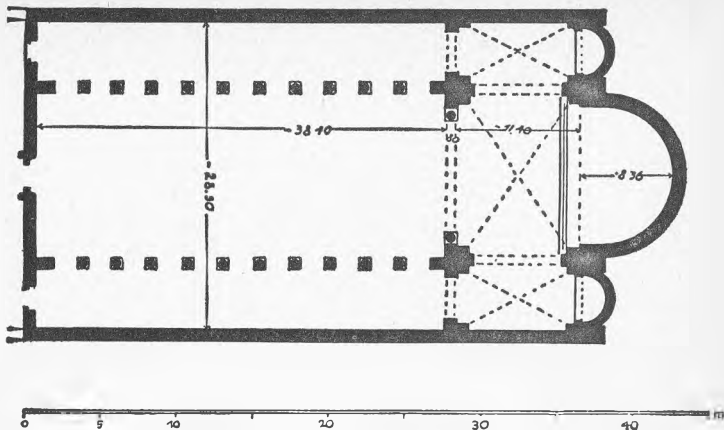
Rom. San Pietro in Vincoli (432-446). Grundriß
